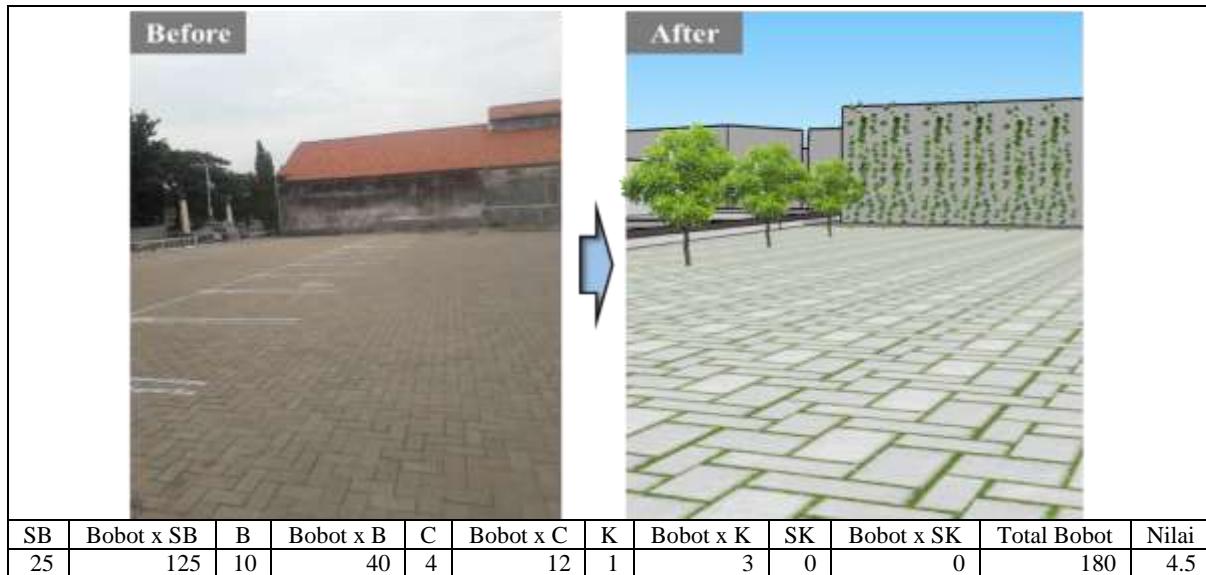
Sampel Penerapan Desain Jalan Utama Depan Gedung Marba
